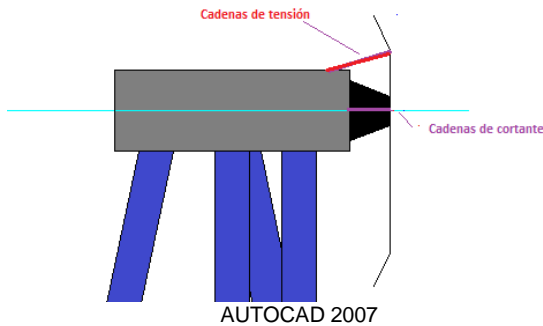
Vista en perfil de las cadenas de cortante y tensión en la estructura (Fuente: del Autor)
